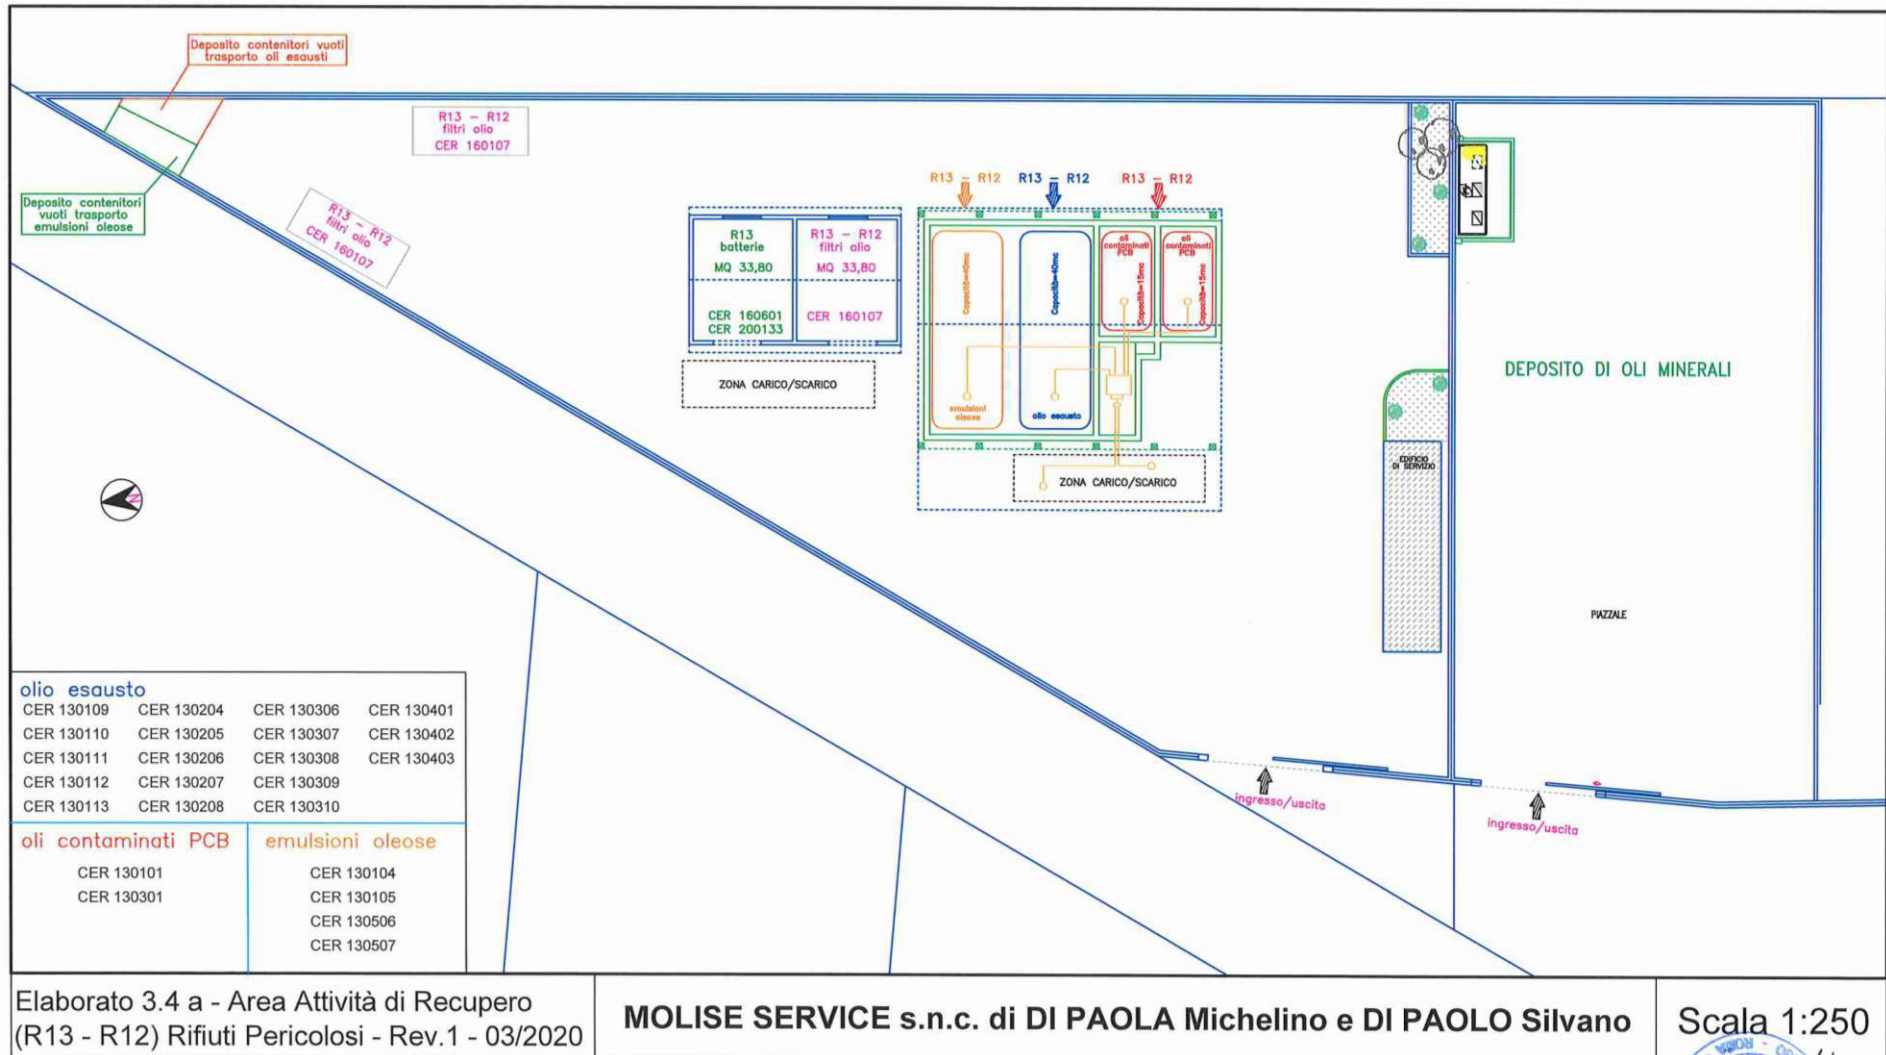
planimetria generale dell'installazione con indicazione delle zone di svolgimento delle operazioni di gestione rifiuti
